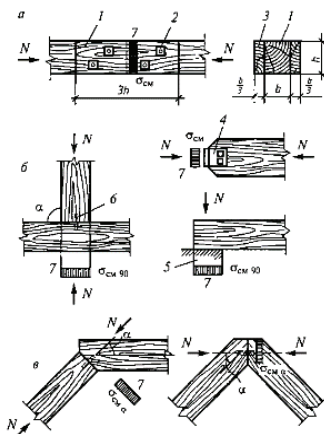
Лобовые упоры: а – продольный вдоль волокон древесины; б – поперечный поперек волокон; в – наклонный под углом к волокнам; 1 – элементы; 2 – стяжные болты; 3 – накладки; 4 – стальные крепления; 5 – опора; 6 – штырь; 7 – эпоры напряжений смятия; а – угол смятия.
